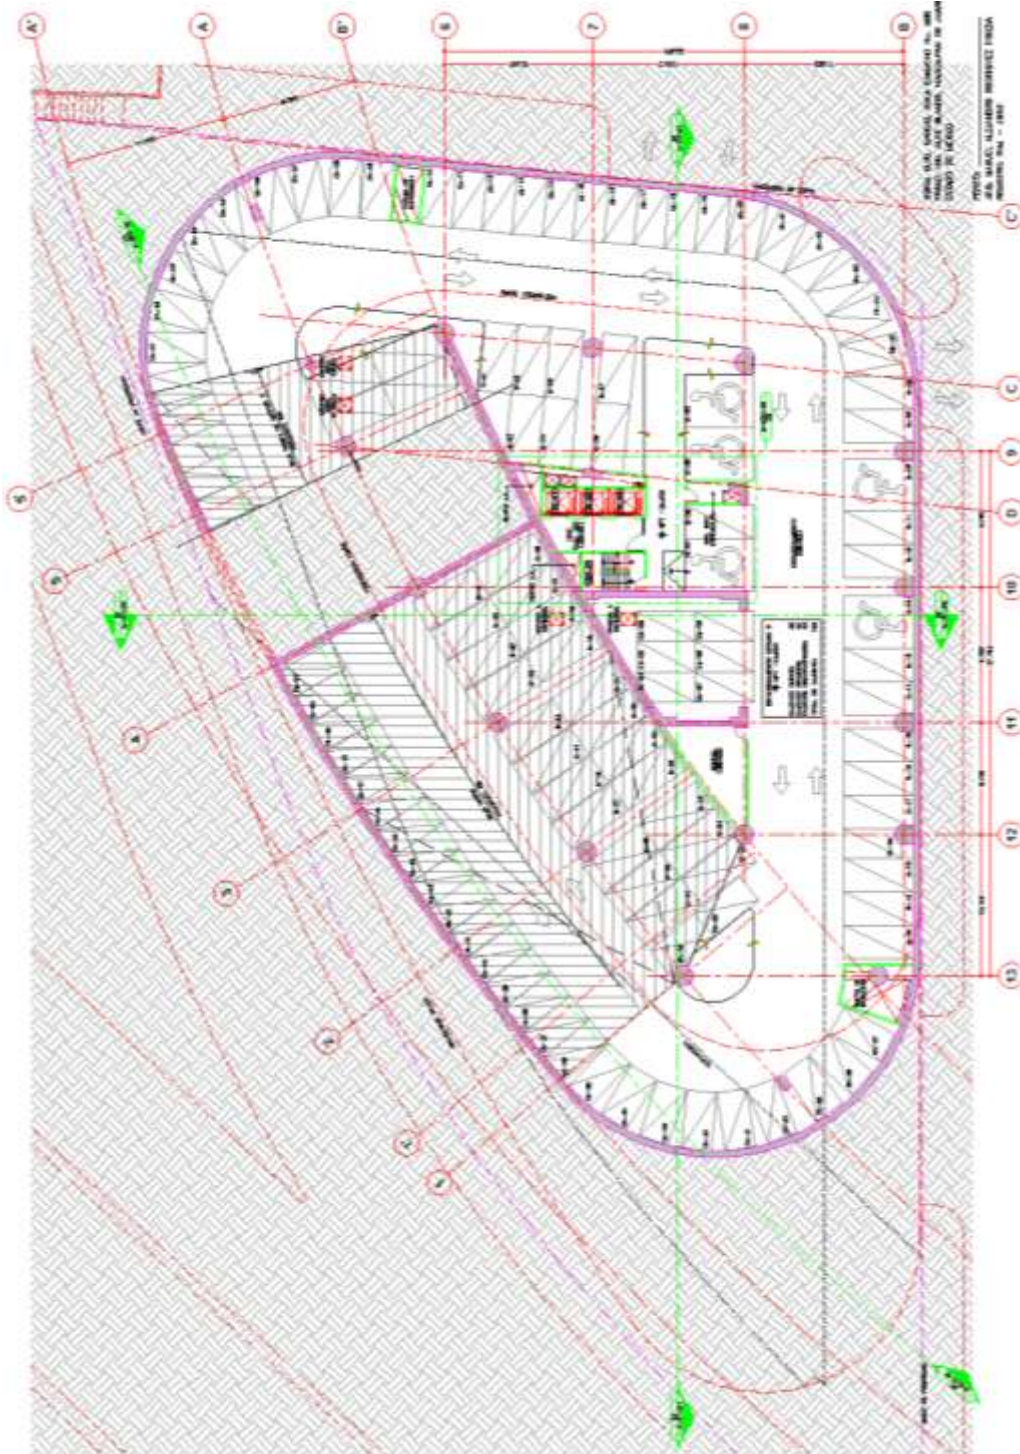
ANTEPROYECTO PLANTA ARQUITECTONICA SOTANO 6
